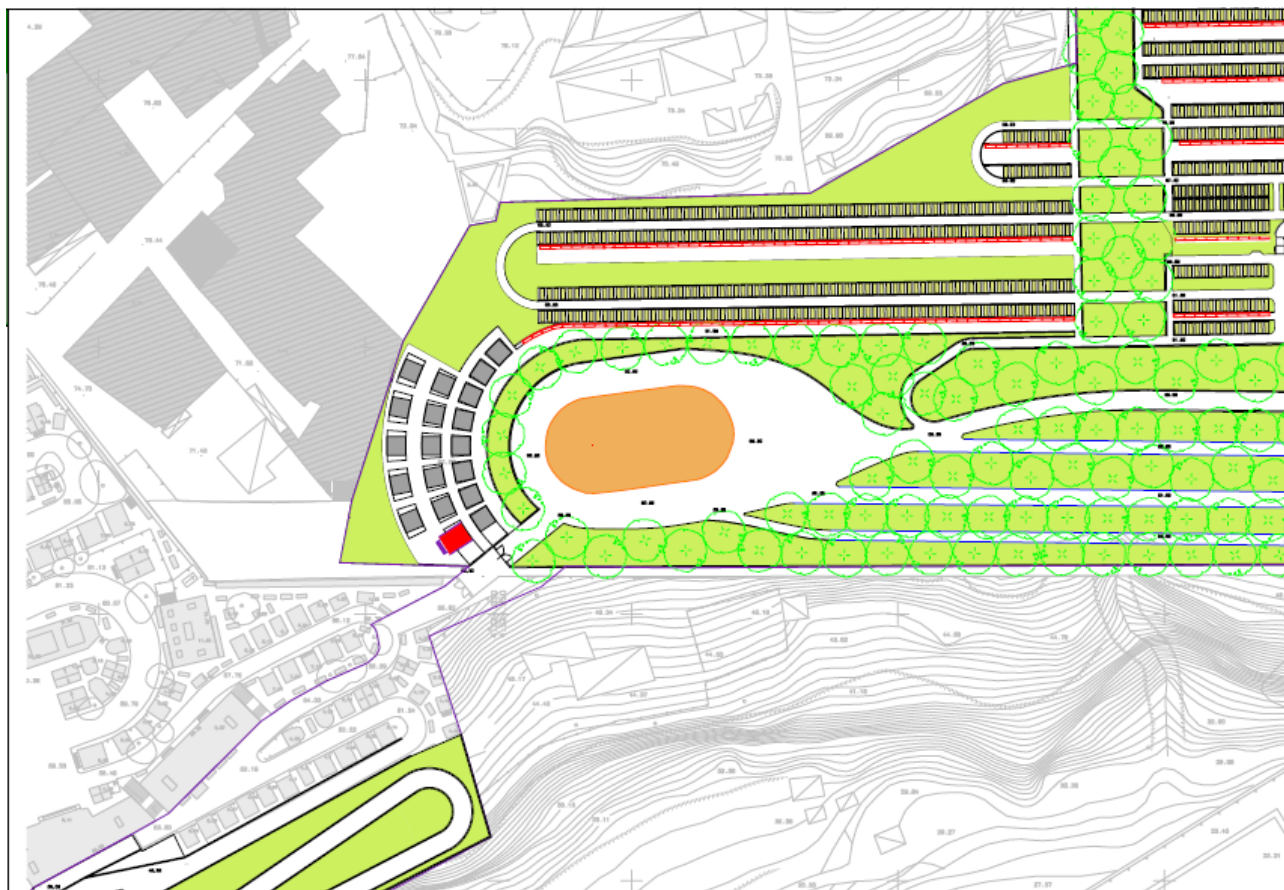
Progetto Preliminare - Pianta Area tra di collegamento tra Santa Maria del pianto e Fondo Zevola - Elaborato PR_AR_004.04
